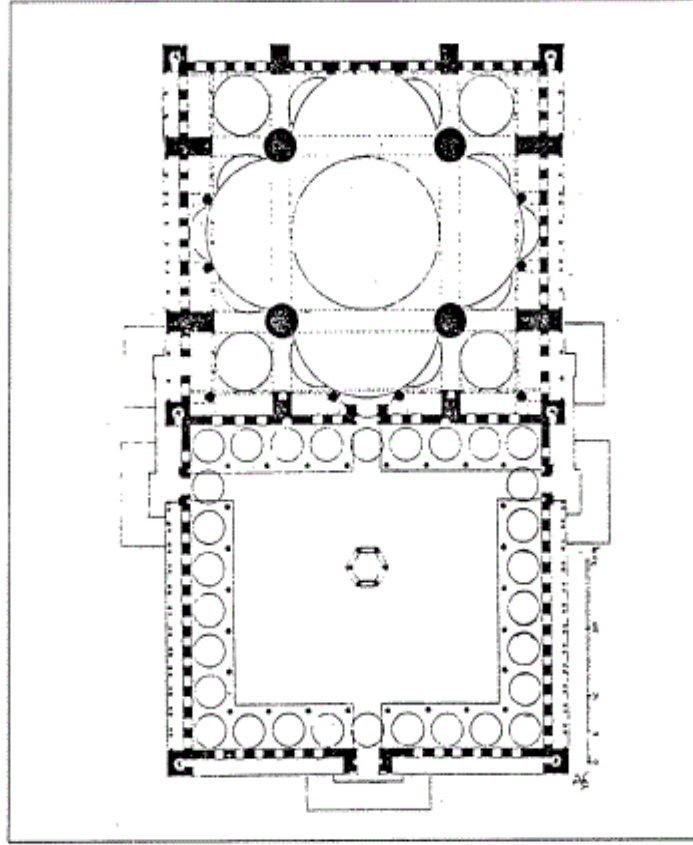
مسقط أفقي لمجمع السلطان بايزيد في إستانبول (عن : جابريل) .
